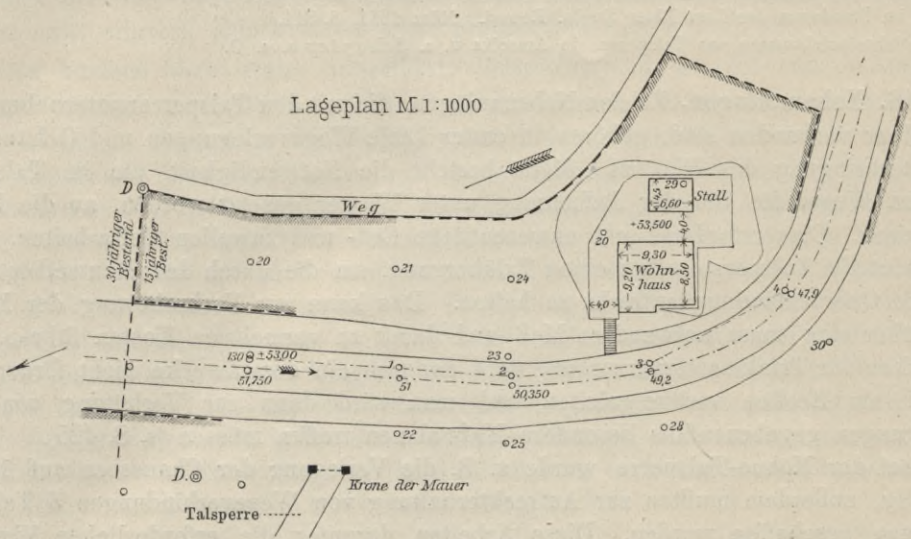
u. 268. Lage und Grundriß des Wärtergebäudes an der Talsperre der Stadt Nordhausen a. Harz.
